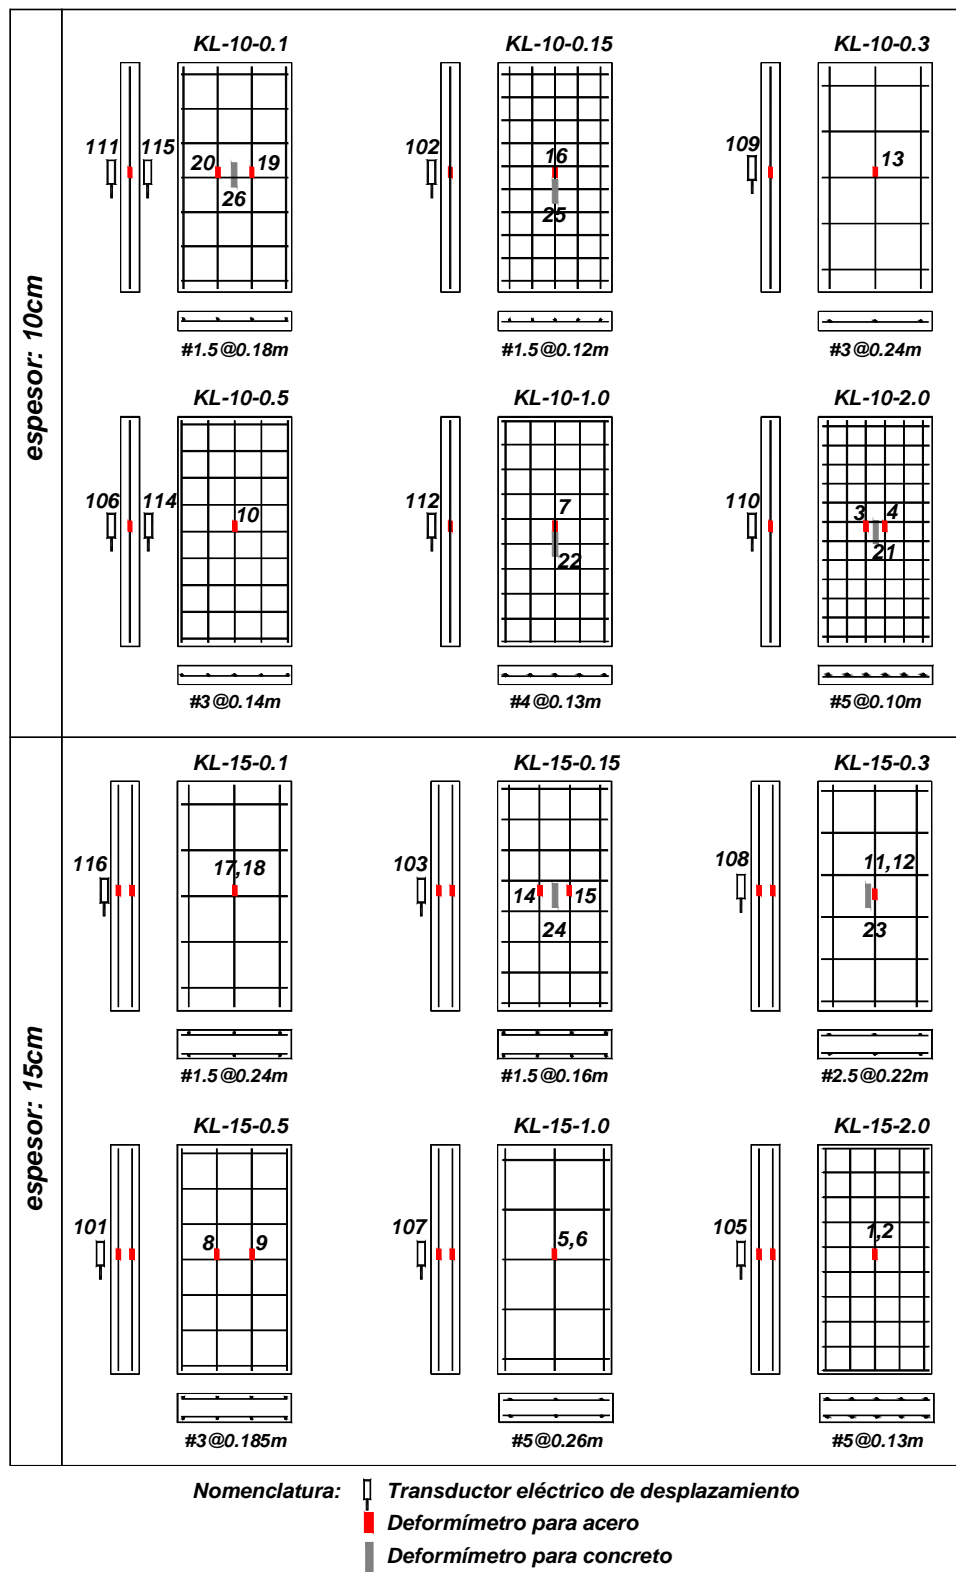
Distribución del acero de refuerzo en las losas y ubicación de instrumentos de medición
